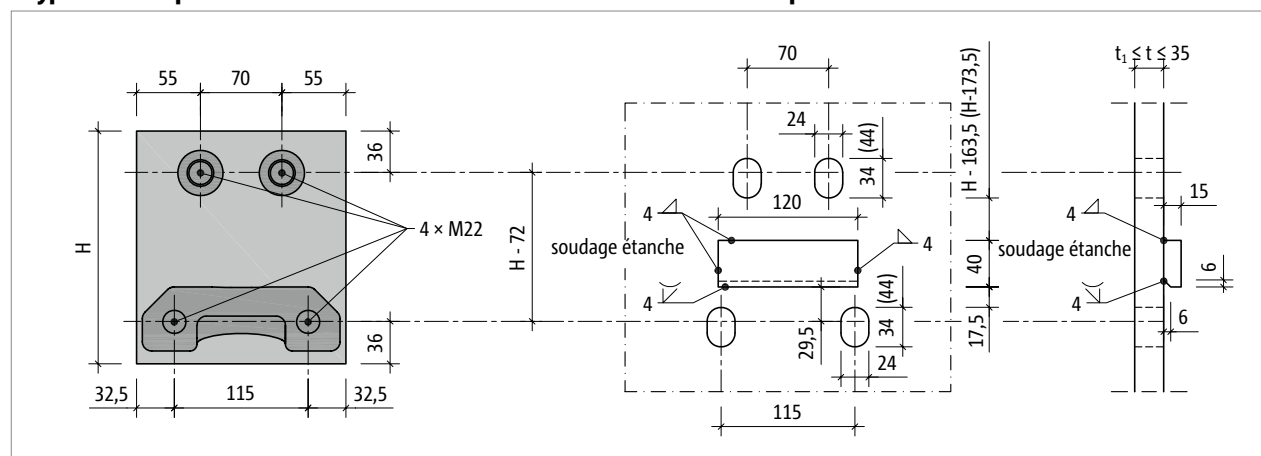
Schöck Isokorb® T type SK-MM2 : construction de la platine frontale de raccordement
